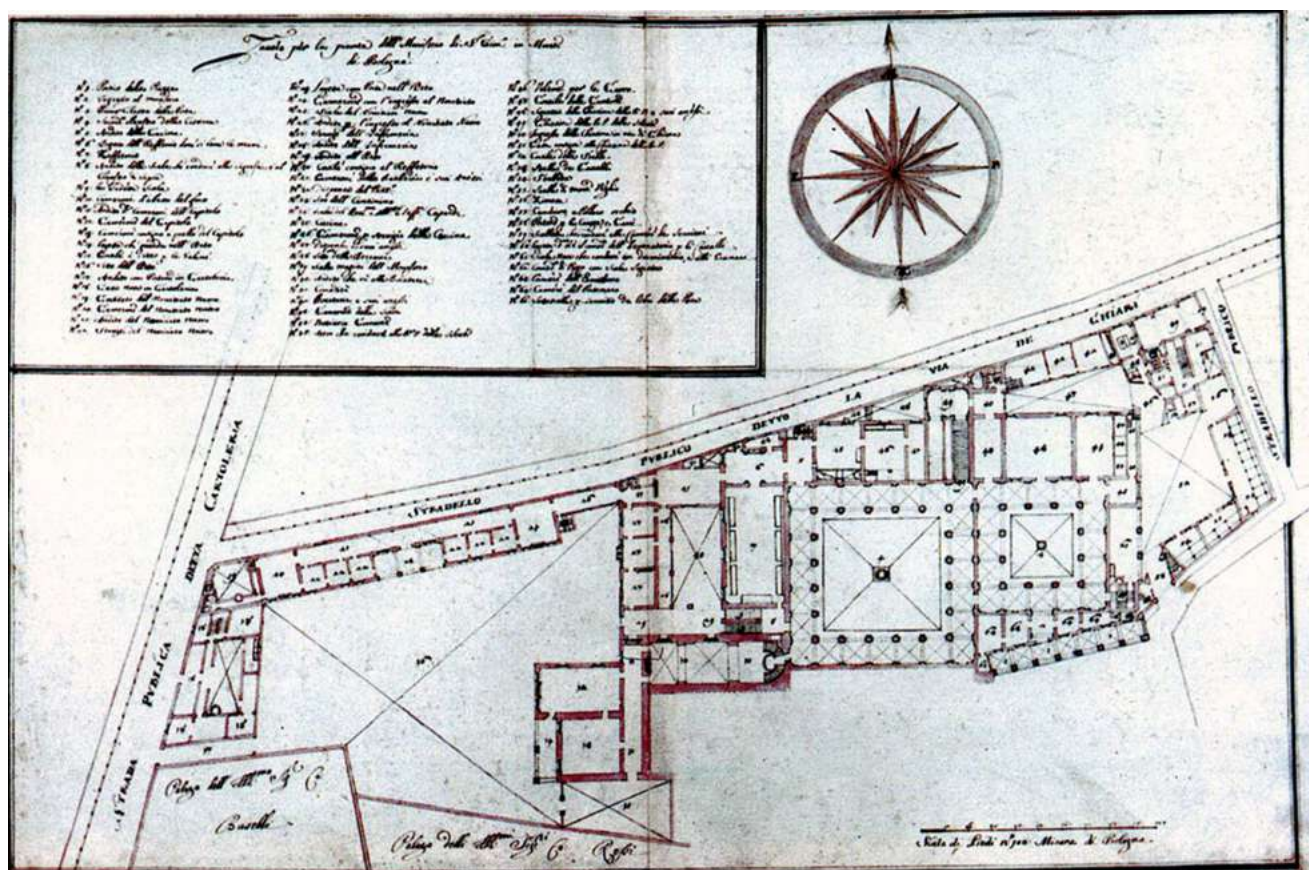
Bologna, Archivio di Stato, pianta di Alfonso Torreggiani, 1708.
